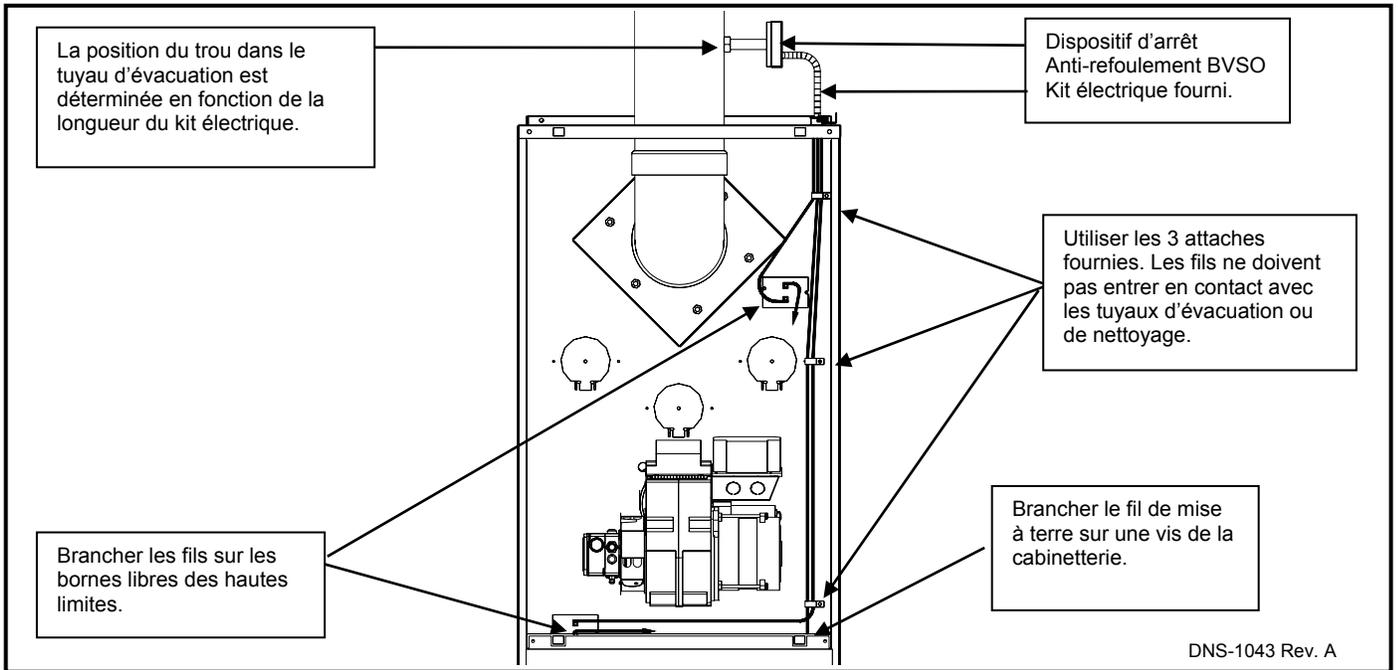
Arrangement général du système anti-refoulement, installation en débit d'air ascendant et évacuation verticale
